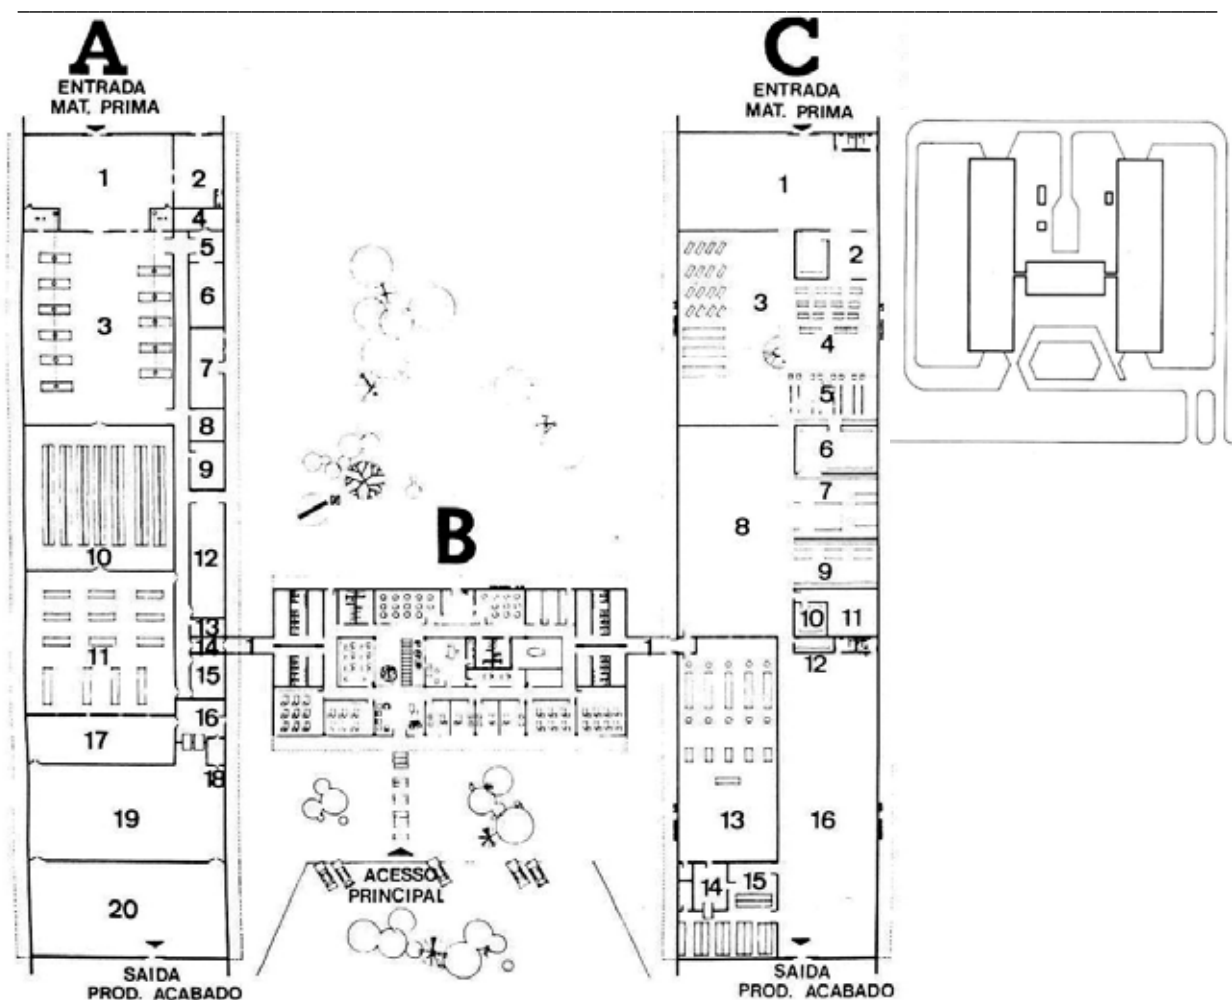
planta pavimento térreo: BLOCO A (fábrica de seringas): 1) depart. de matéria-prima; depart. de sobra de materiais; 3) depart. de injeções; 4) peças; 5) serviço; 6) oficinas/ máquinas; 7) ar-condicionado/compressor; 8) supervisor; 9) testes; 10) depart. de componentes; 11) depart. de montagem/ graduação/ embalagem; 12) depart. de material de embalagem; 13) enfermagem; 14)0 eclusa; 15) lavagem de containers; 16) esterilização; 17) depart. de acondicionamento; 18) máquinas; 19) quarentena; 20) estoque. BLOCO B (administração) 1) passarela; BLOCO C (fábrica de agulhas): 1) depart. de matéria-prima/ plástico/aço; 2) soldagem; 3) depart. de plásticos; 4) estiramento; 5) retificação; 6) inspeção; 7) corte/ limpeza; 8) depart. de componentes; 9) corte final; 10) estoque; 11) limpeza; 12) epóxi; 13) depart. de montagem/graduação/embalagem; 14) esterilização; 15) quarentena; 16) estoque.
